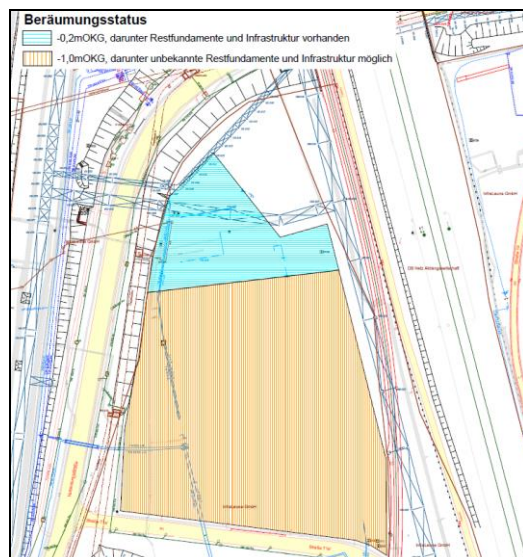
Ausschnitt aus dem Lageplan mit ehemaliger Bebauung (s. Anlage 2.2)
